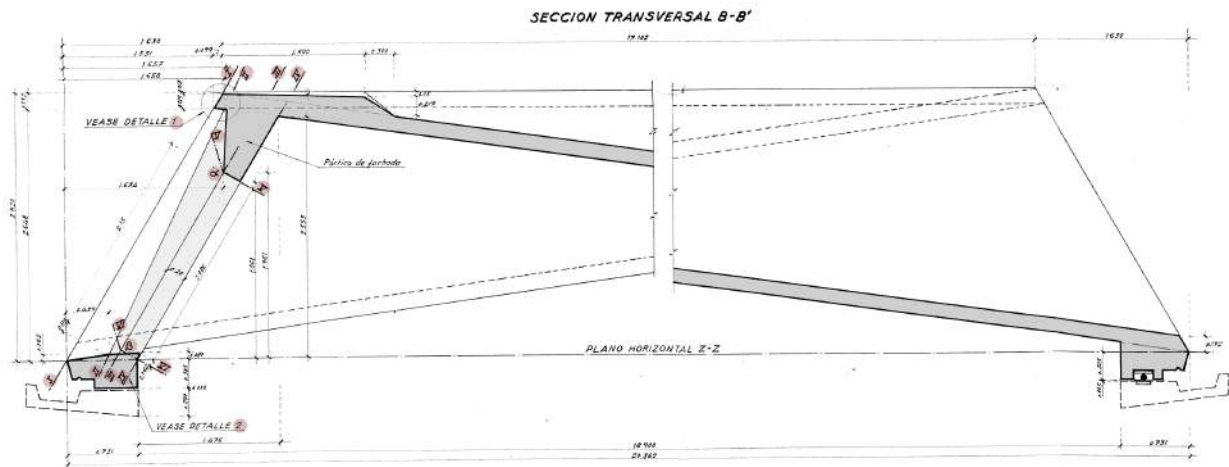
SECCIÓN TRANSVERSAL B - B'
